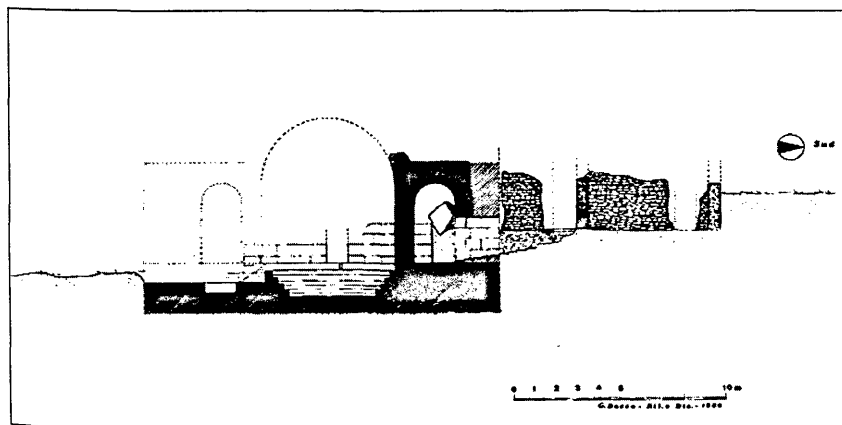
Forum Traiani: sezione C-C' (Nord-Sud) dell'impianto termale.
